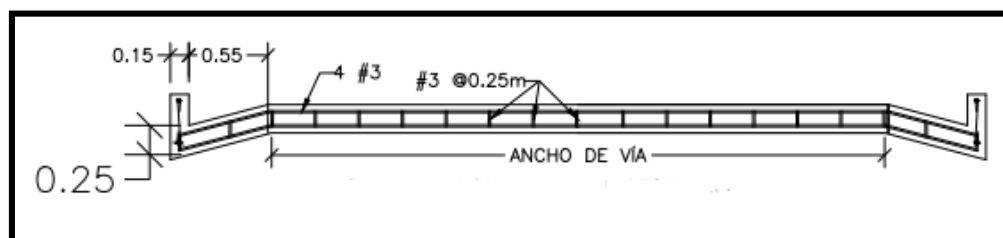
Sección longitudinal de la viga riostra Fuente: Tomado de Cartilla de Obras menores de drenaje y estructuras viales del Instituto Nacional de Vías
